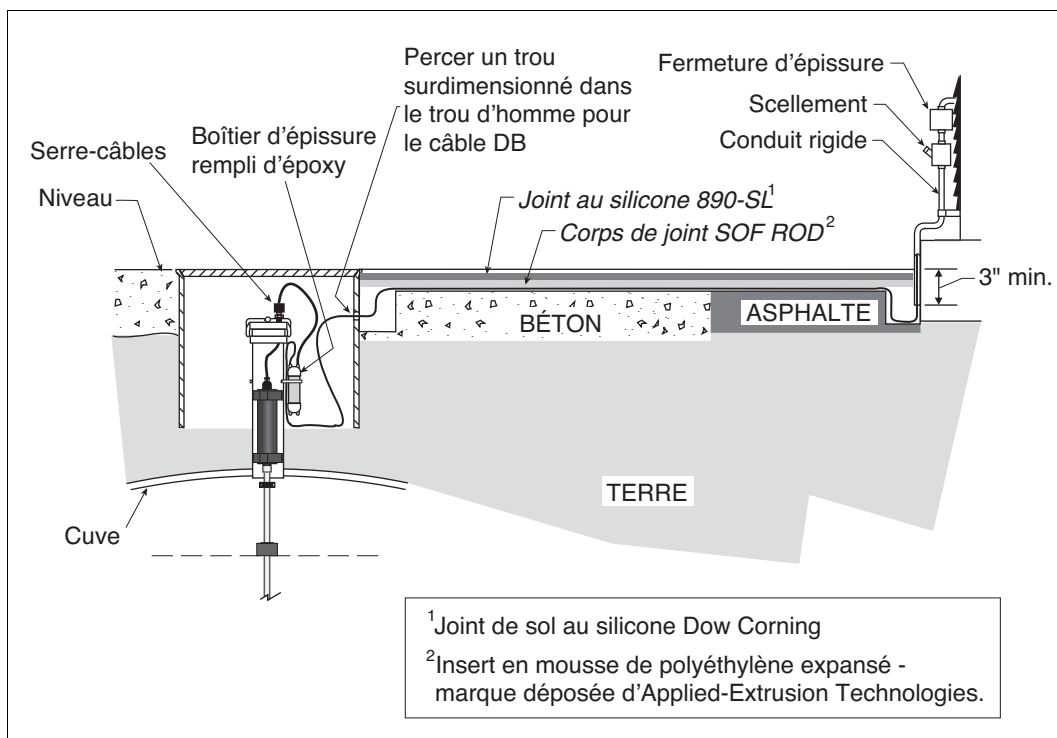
Exemple d'acheminement de câbles de sondes en pleine terre
